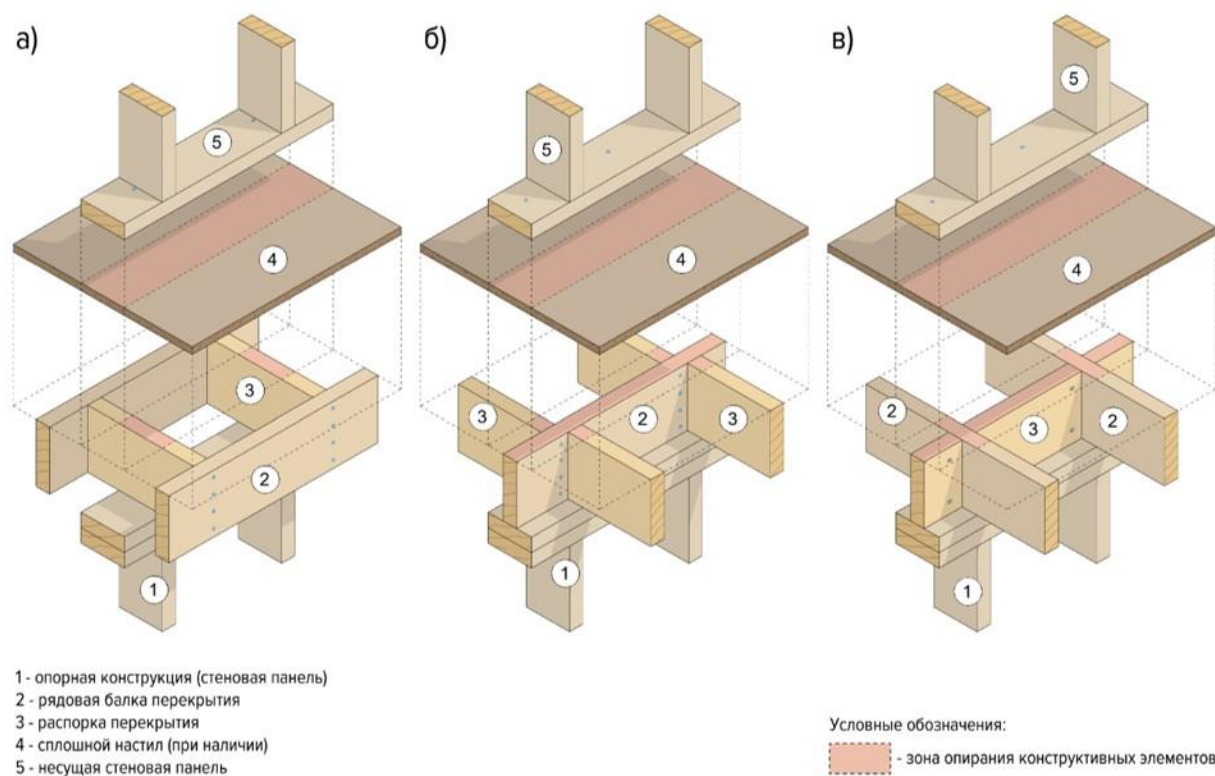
Допустимое смещение несущих стен от опорной конструкции
